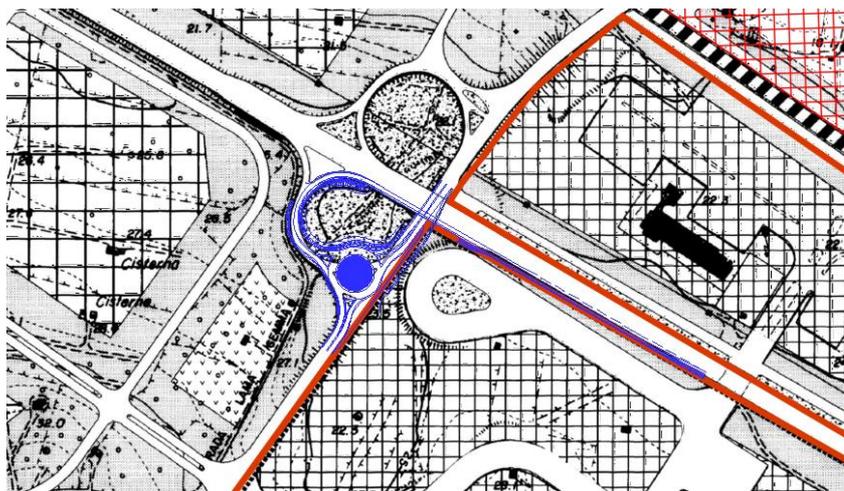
Stralcio sovrapposizione "Bretella di collegamento" al PRGC Molfetta
